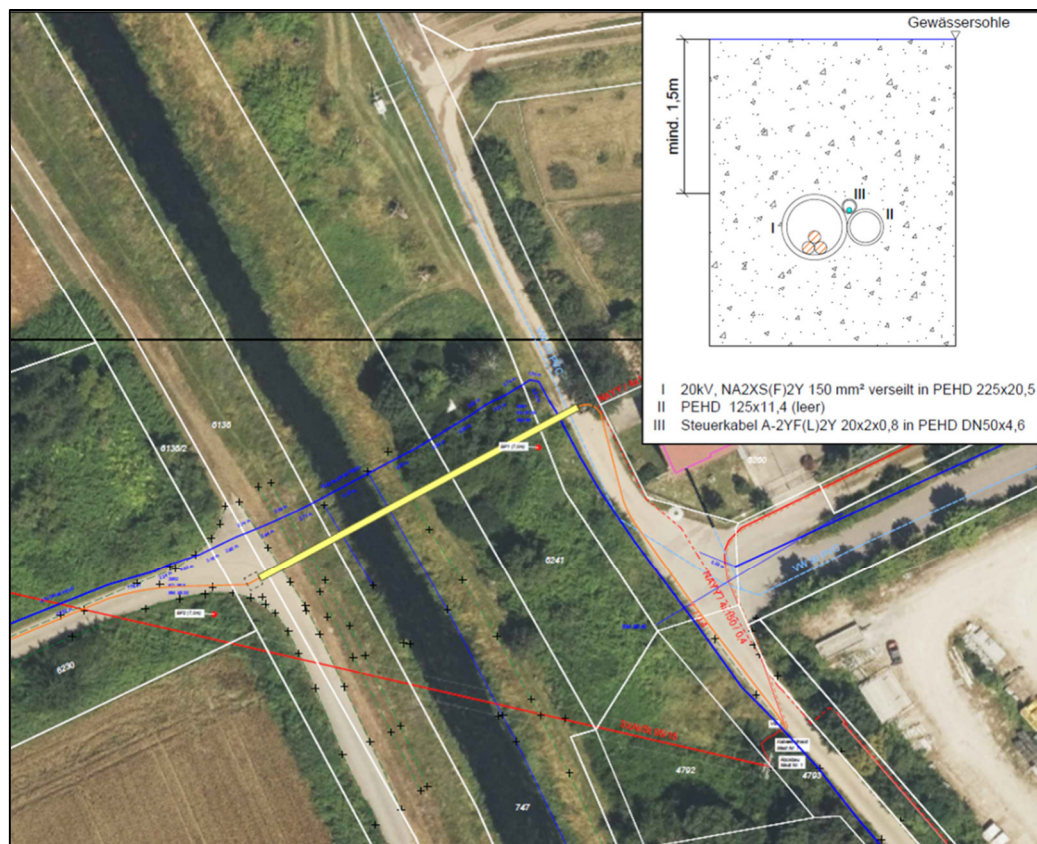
Lageplan mit der geplanten HDD-Bohrung unter dem Kraichbach mit vorgesehene Grabenprofil.
